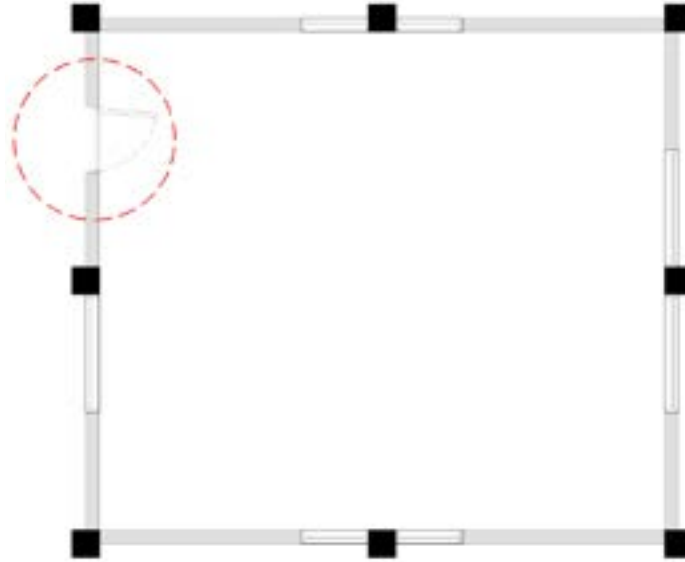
Planta esquema circulaciones Bloque No.15.
